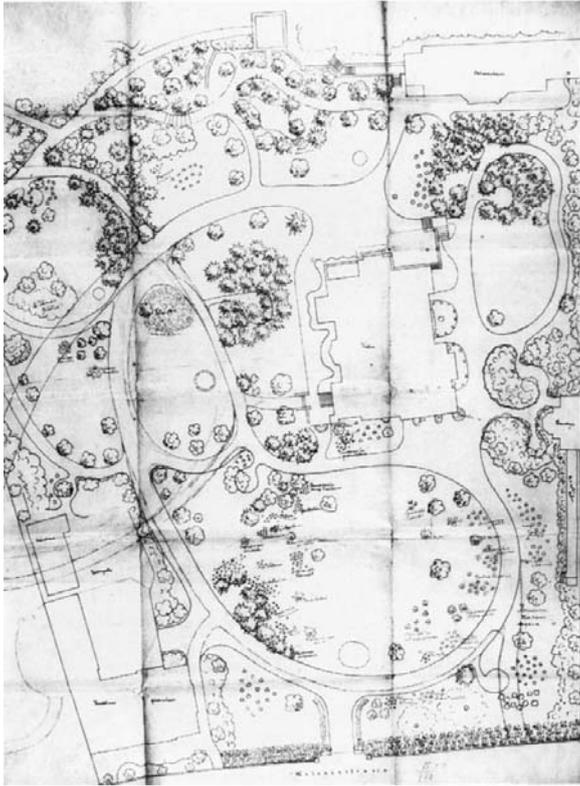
Villa Helenenstraße 72 in Baden. Situationsplan. 1882/84.
